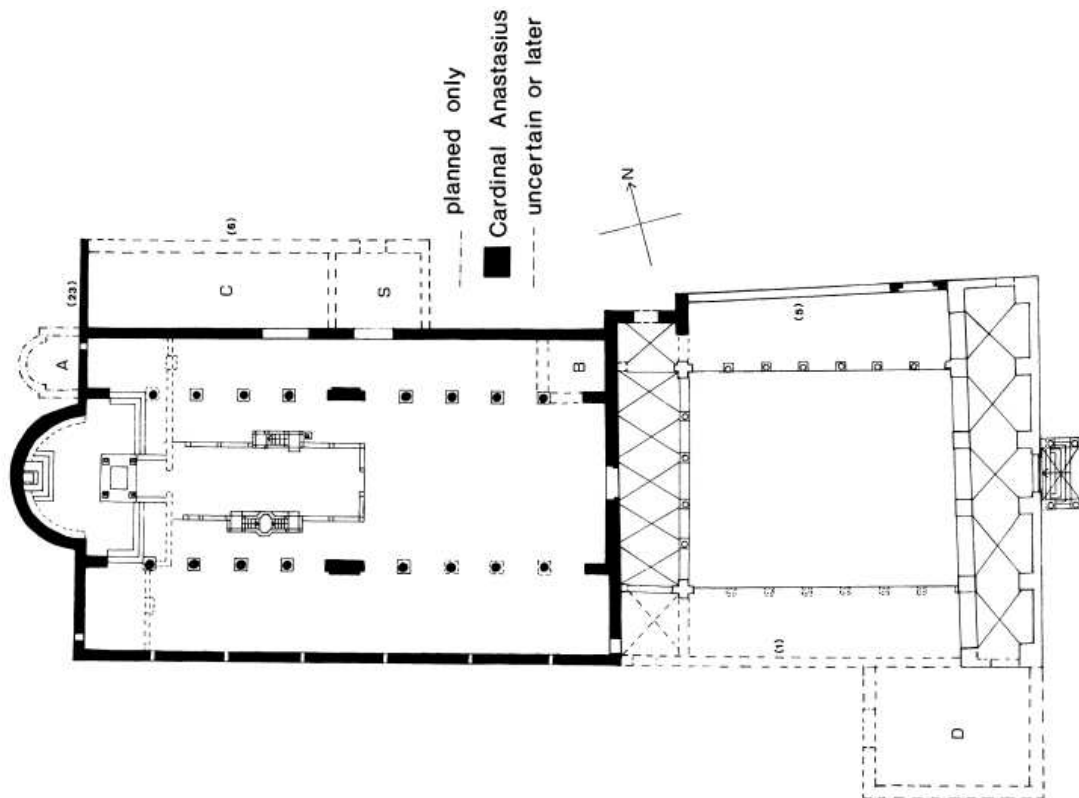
Grundriss San Clemente, ab 1099 – ca. 1126, Rom.
